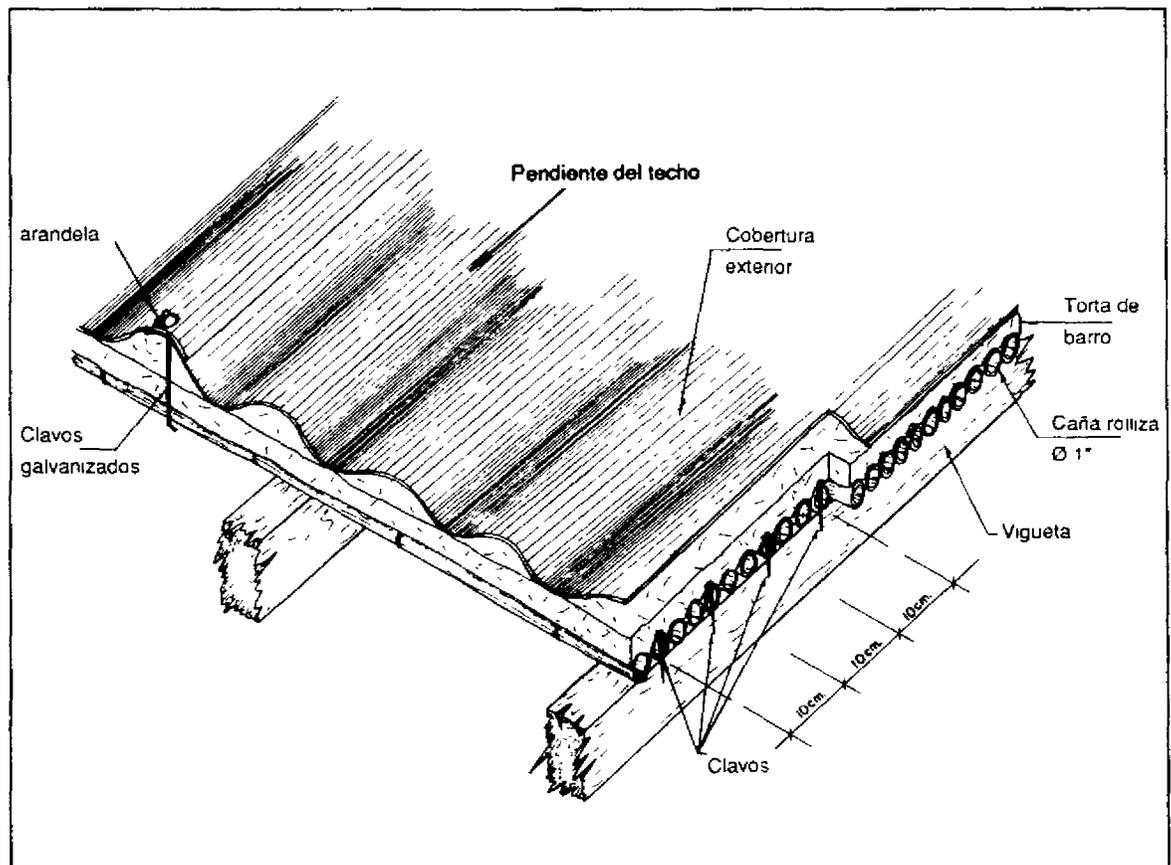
Detalles del techado usando caña con barro y cobertura de lámina
